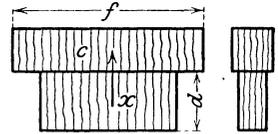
Zugenieteter Zahn zu Fig. 57.
